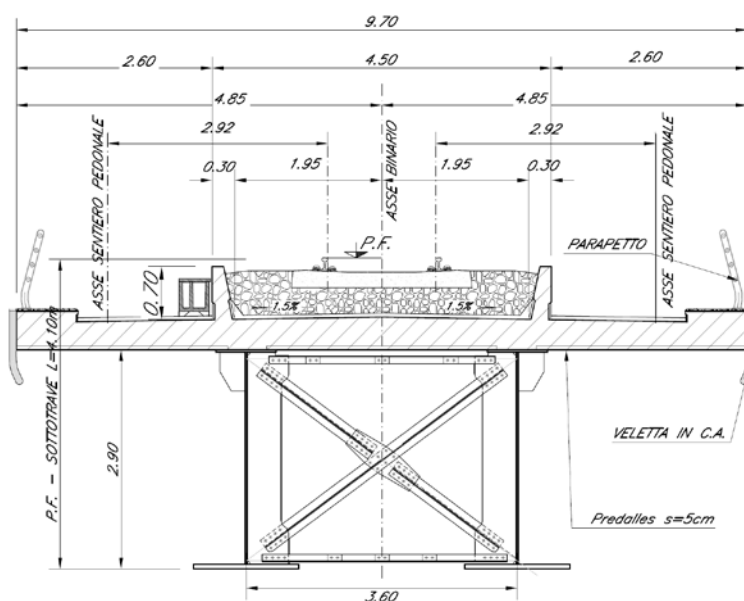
Sezione trasversale campate in acciaio-clc L=40 m
